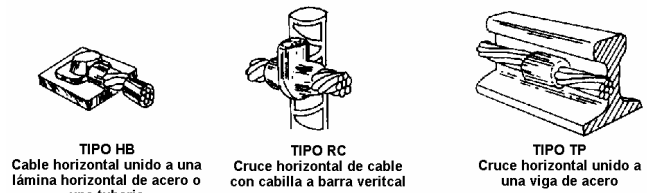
Soldaduras tipo conductor a estructuras
